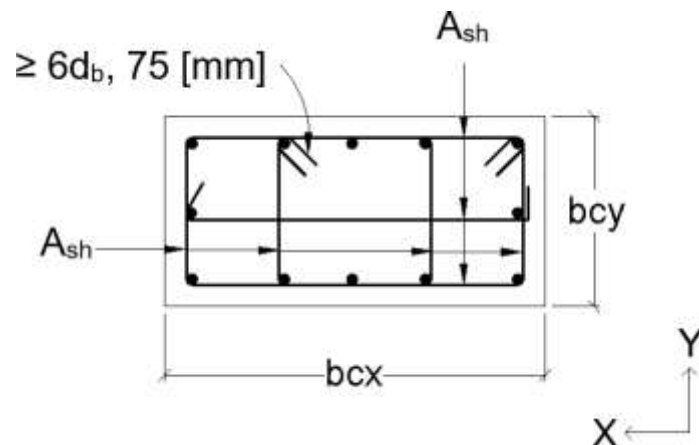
Refuerzo transversal por confinamiento en columnas. [Elaboración propia]
